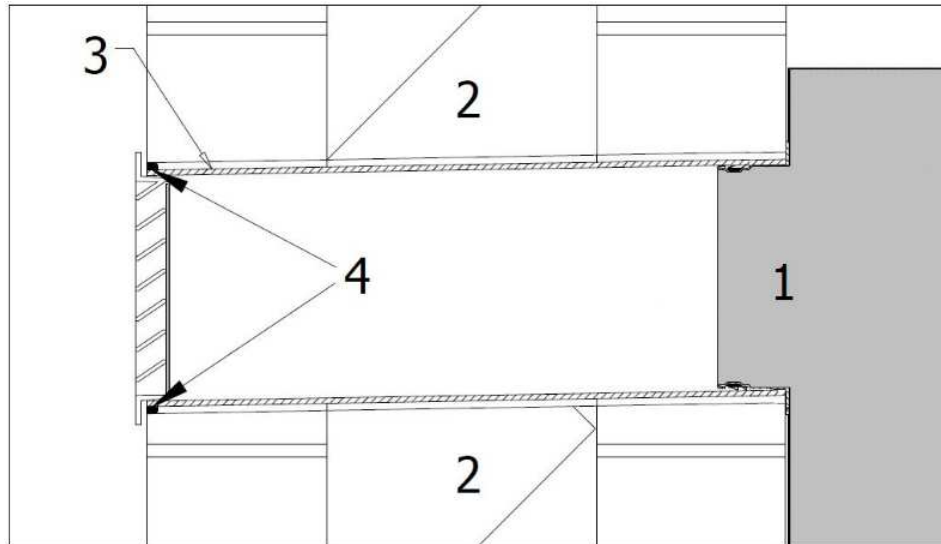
Abdichten der Fugen rund um die Kanäle, Schnittzeichnung
